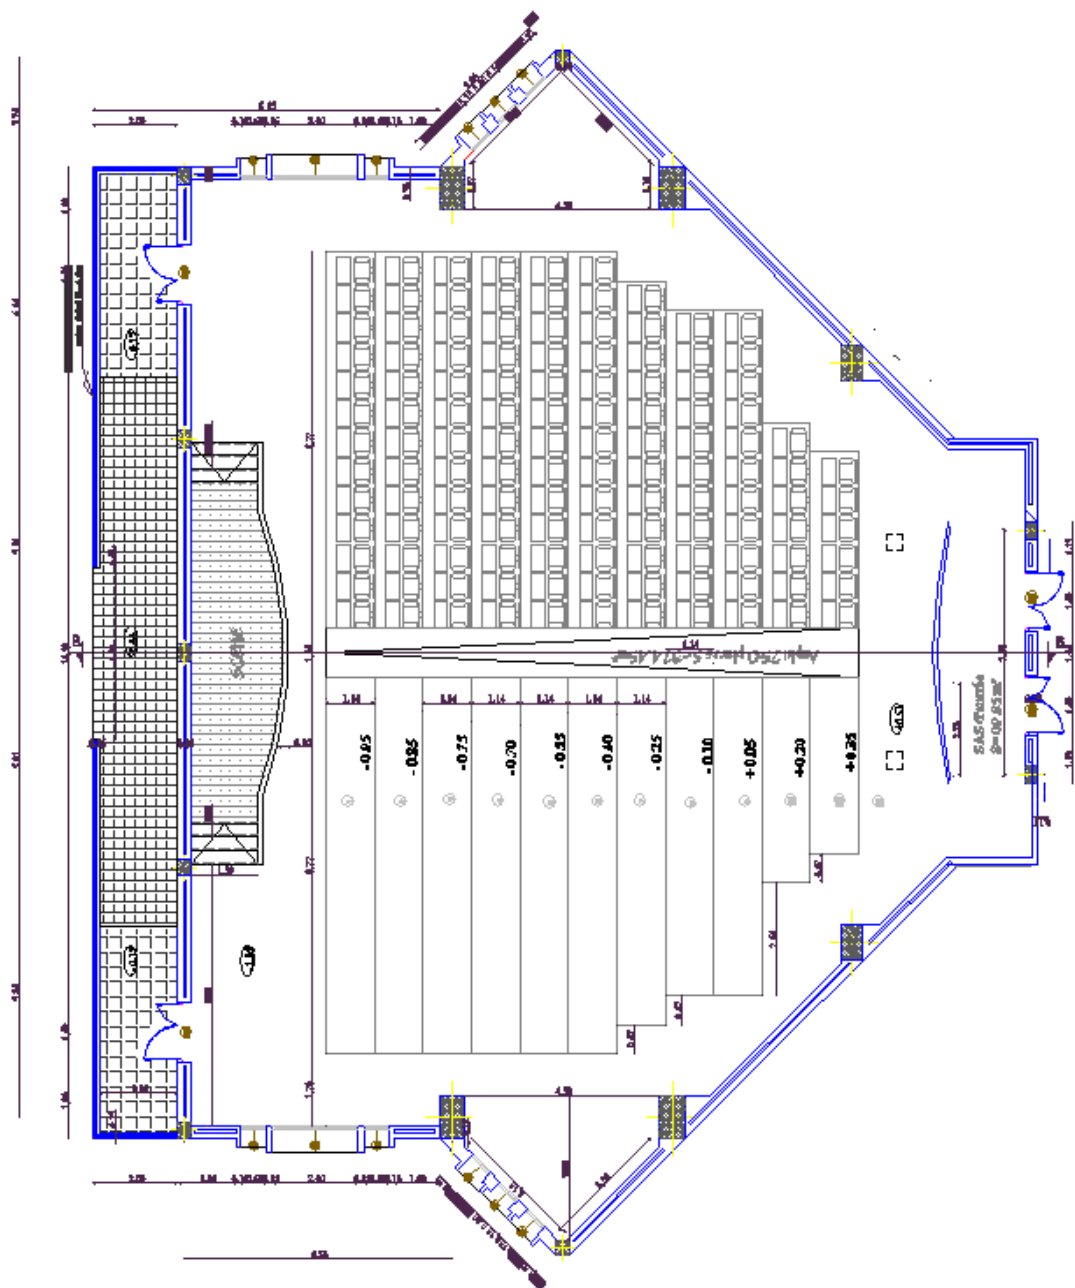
Plan d'architecture échelle 1/150.[2].
